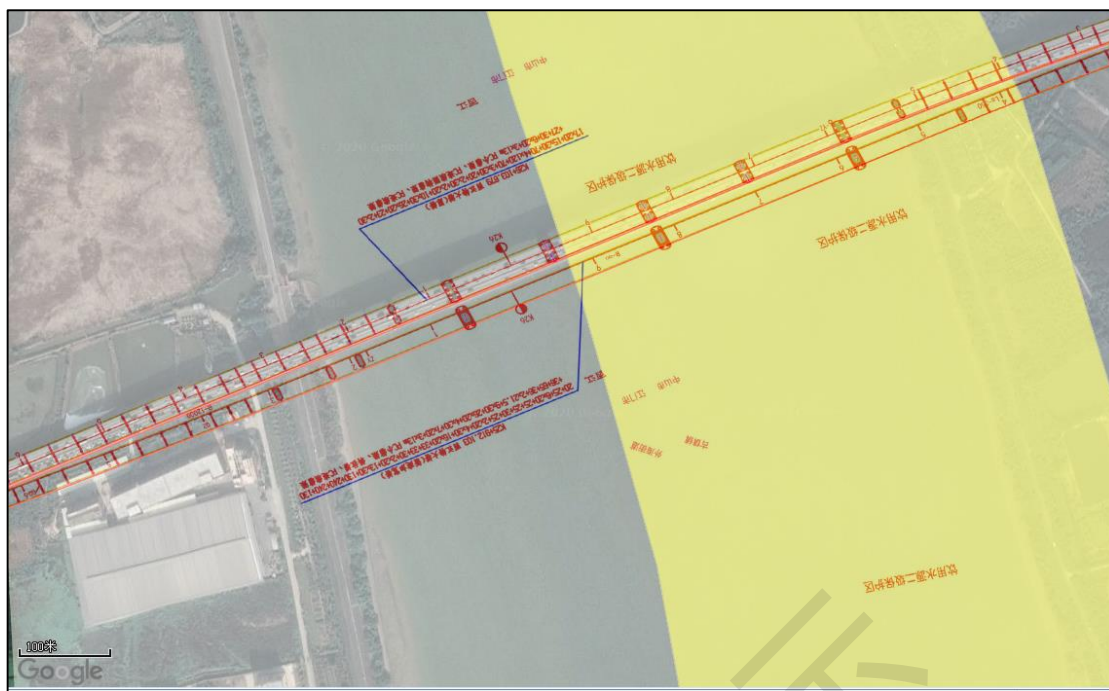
西江特大桥扩建方案桥位平面示意图
